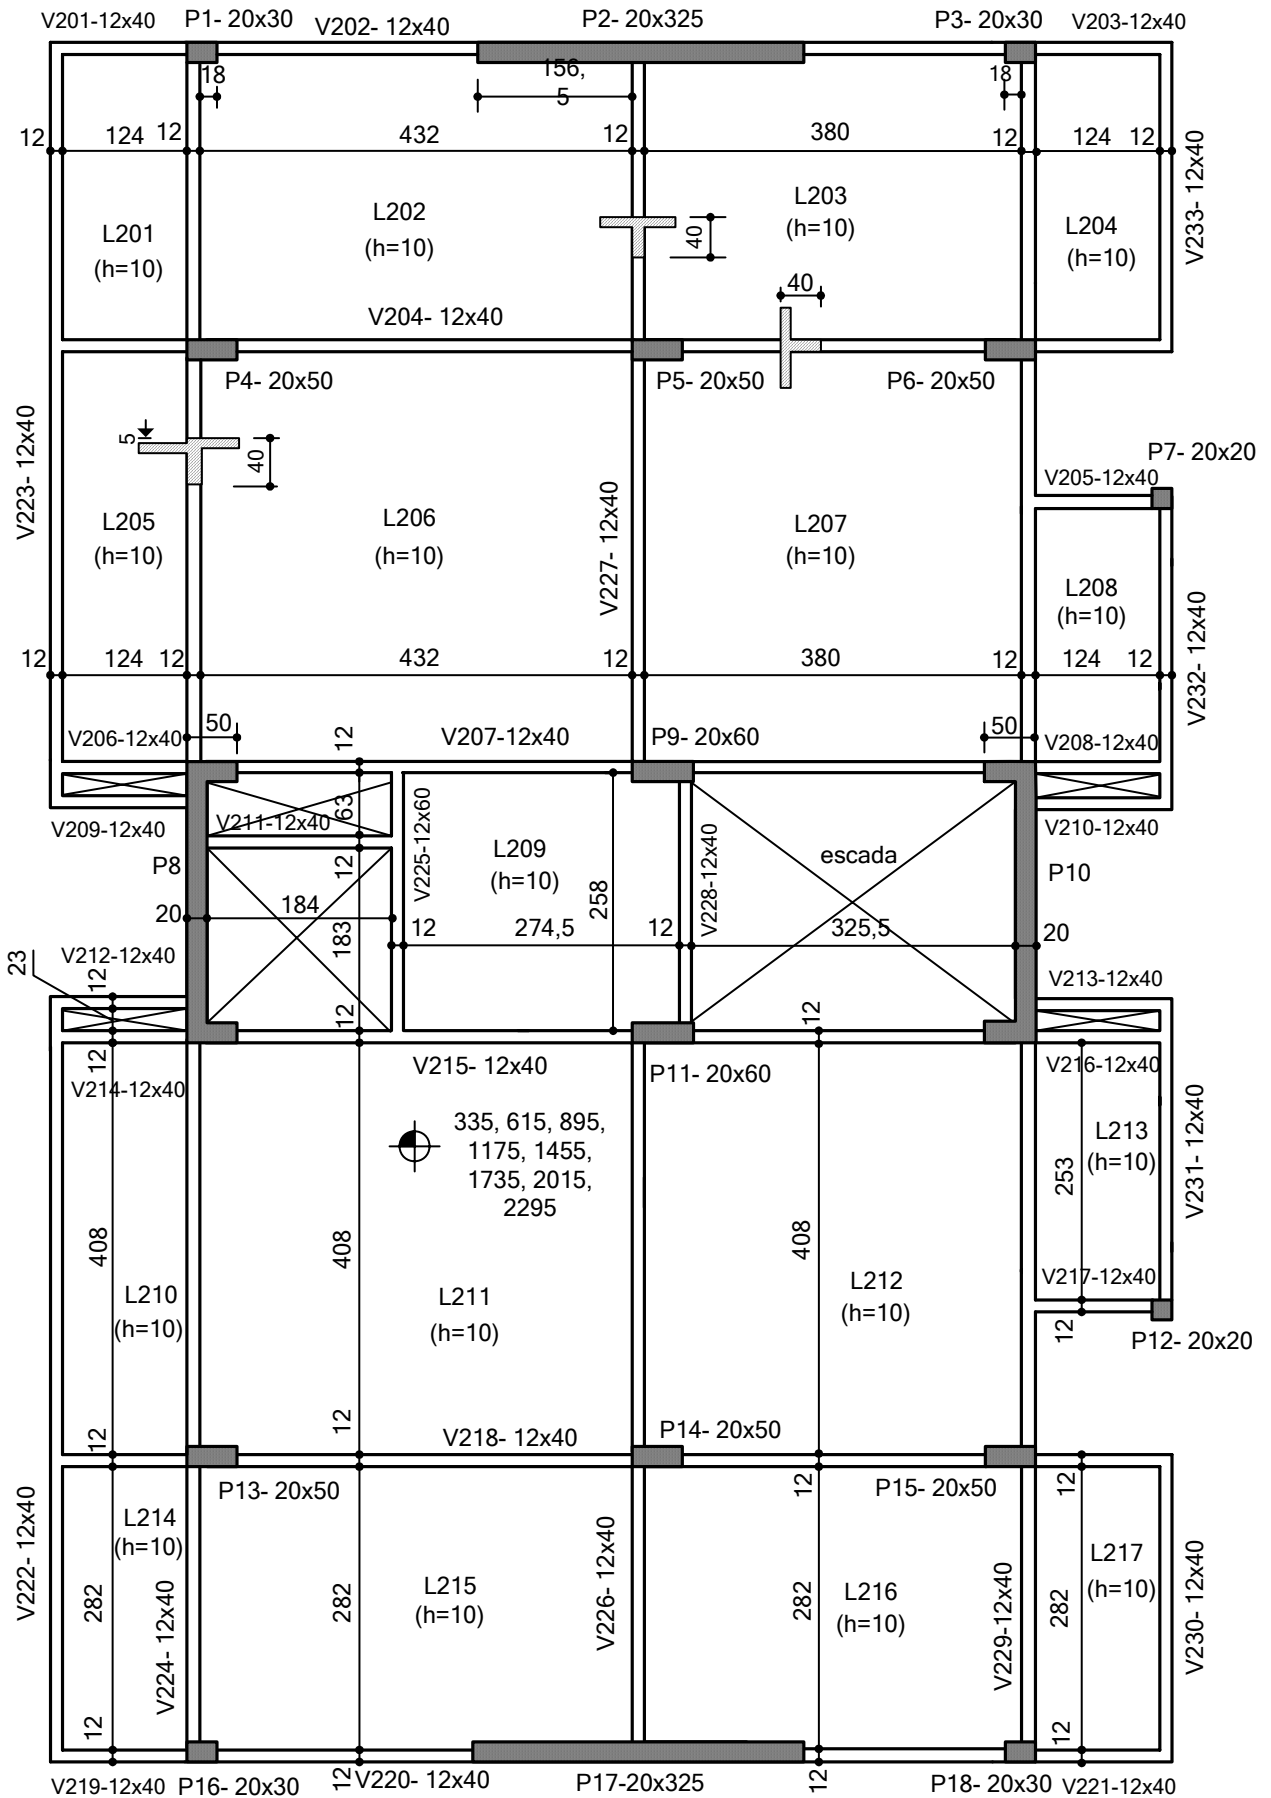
Formas do pavimento tipo – Opção 1
